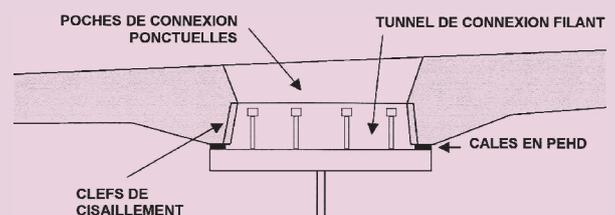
Modalités de liaison entre encorbellements et partie centrale en construction adoptées depuis 2005
